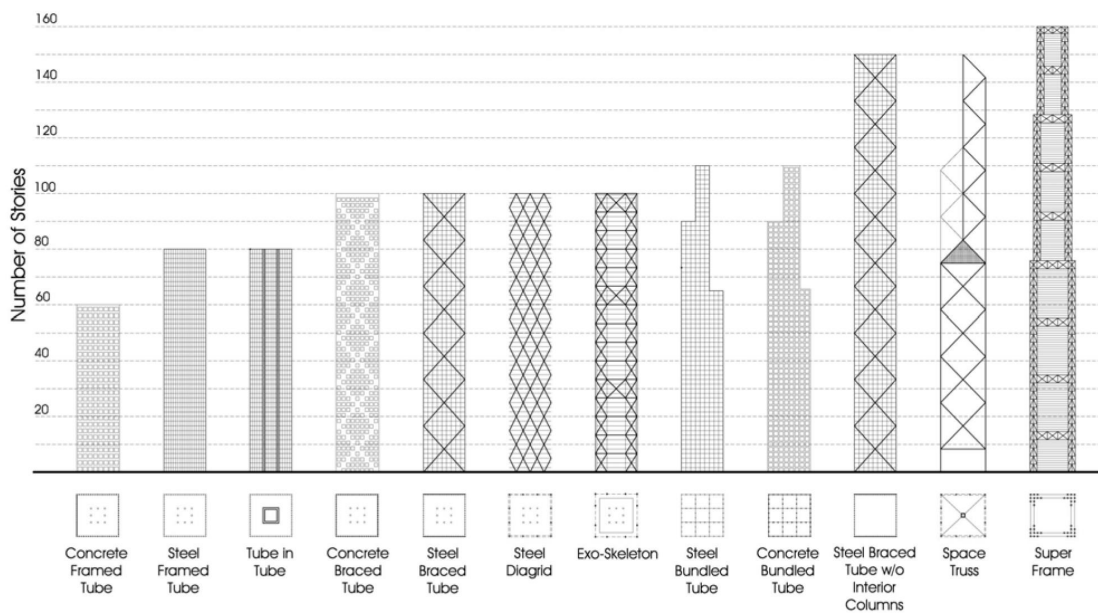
Classificatie van constructiesystemen voor hoogbouw door Fazlur Khan (boven: staal; onder: beton).
